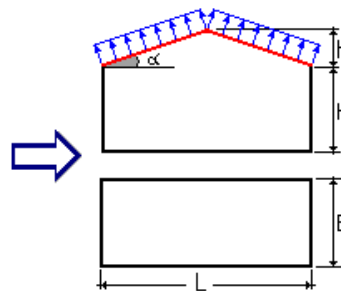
Схема приложения ветровой нагрузки на кровлю
